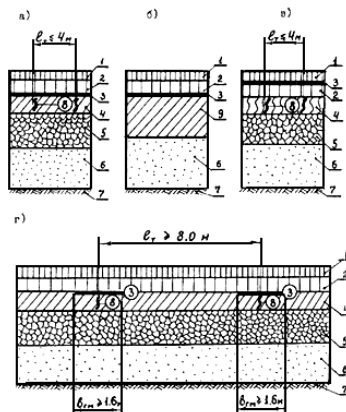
Основные конструктивные решения по устройству трещинопрерывающих прослоек из ГМ: 1, 2 – вновь устраиваемые асфальтобетонные слои усиления; 3 – трещинопрерывающая прослойка из ГМ; 4 – блочное асфальтобетонное основание (старое покрытие); 5 – основание дорожной одежды; 6 – песчаный подстилающий слой; 7 – земляное полотно; 8 – температурная трещина; 9 – слой дорожной одежды, содержащий неорганические вяжущие
